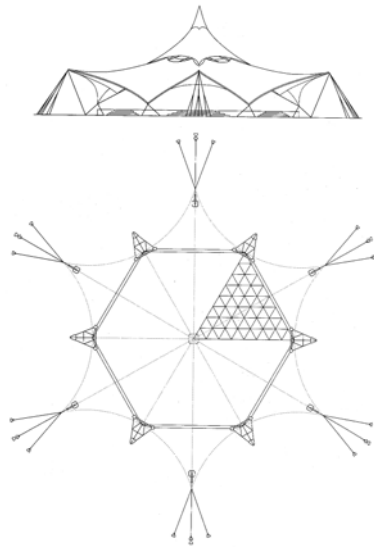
Schnitt, Grundriss (15)
